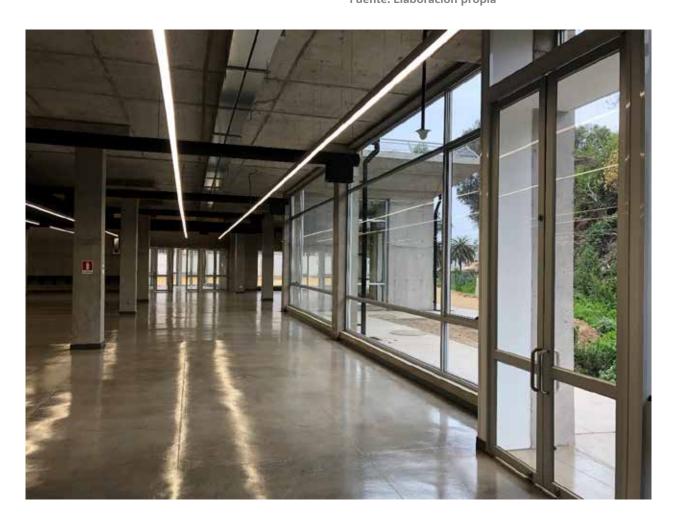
Vista interior detalle ventanal lateral hacia quebrada. Fuente: Elaboración propia
